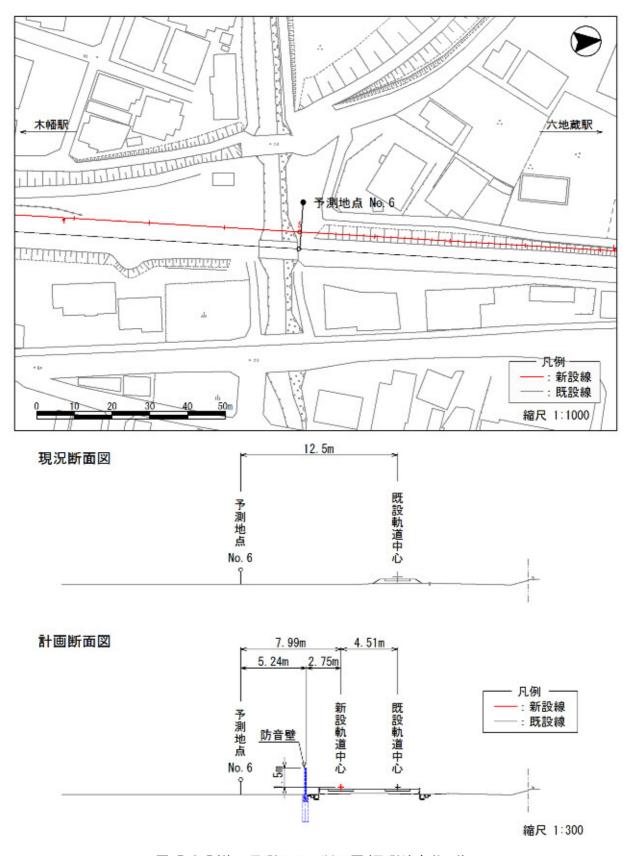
(6) 予測平面·断面図(予測地点 No.6)
